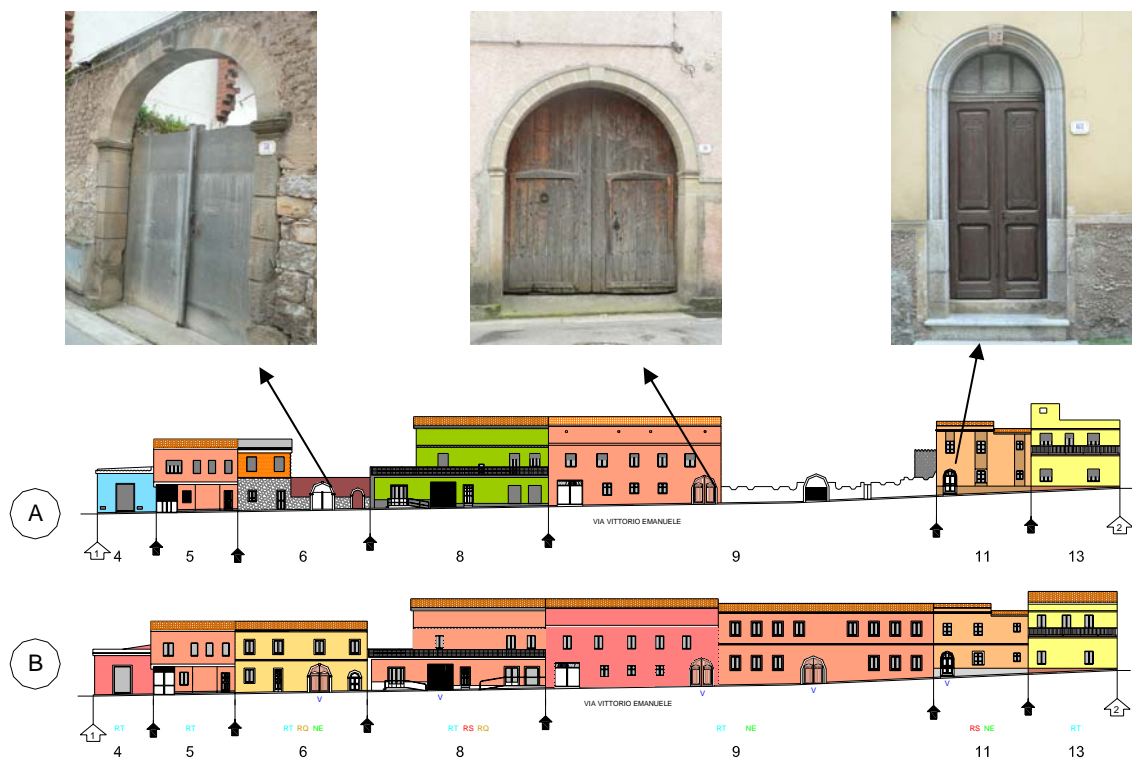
Profilo stato attuale e di progetto lungo la via Vittorio Emanuele nell'isolato B.
